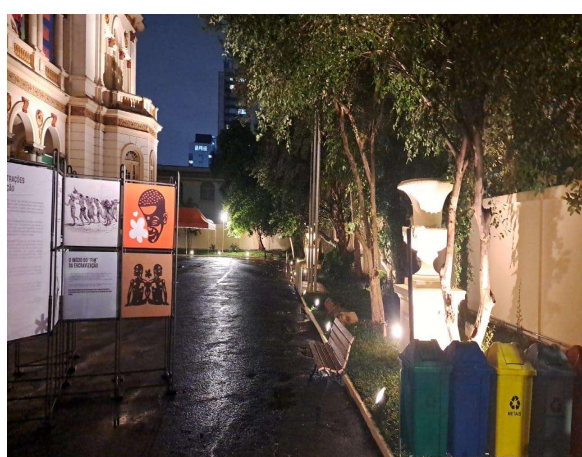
Implantação iluminação externa, fachada Av Rio Branco.
